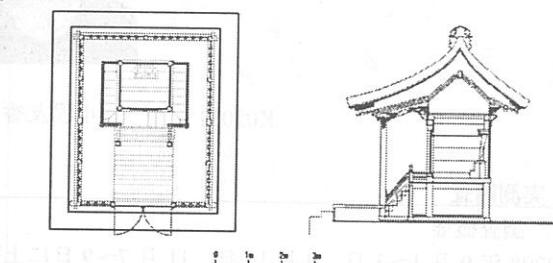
上芦川諏訪神社本殿輪堂平面図、本殿断面図
